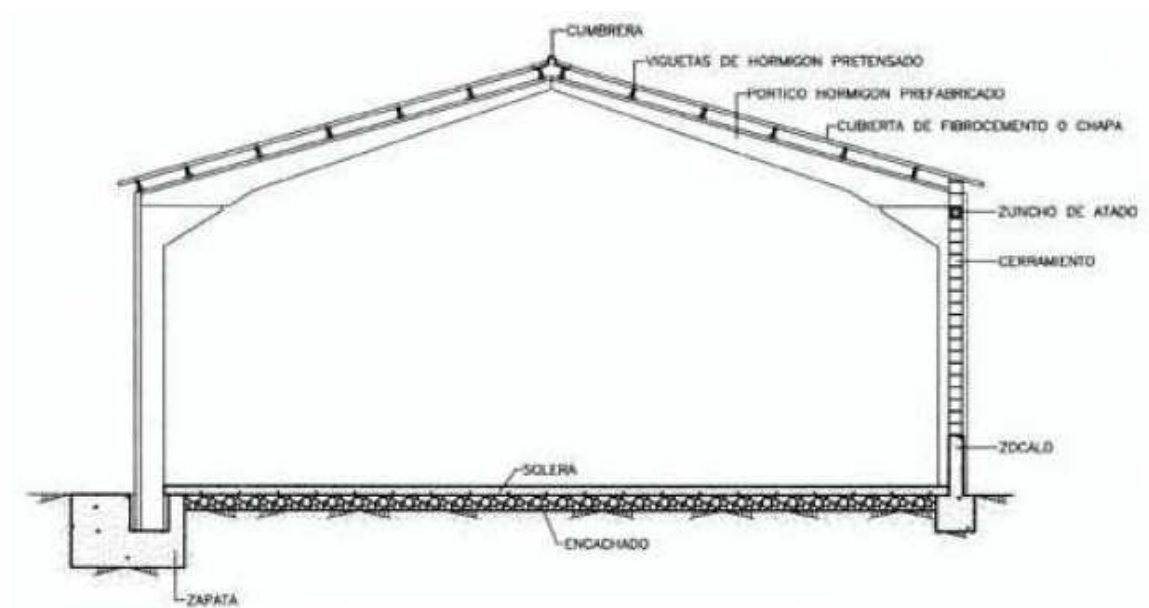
Estructura con pórtico prefabricado de hormigón “4 piezas”.
